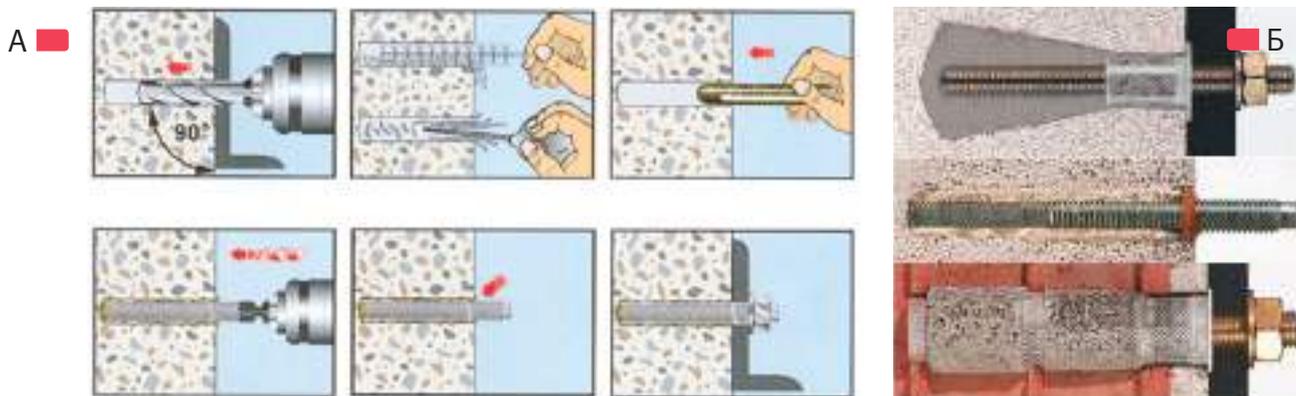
А – последовательность по устройству химических анкеров; Б – типы анкеров при обустройстве в газобетон и в кирпичную кладку
